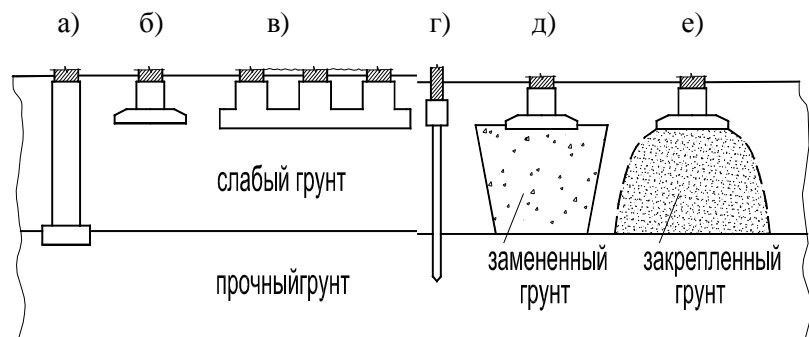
Варианты устройства фундаментов при напластовании грунтов по схеме 3 рис. 2.5.
